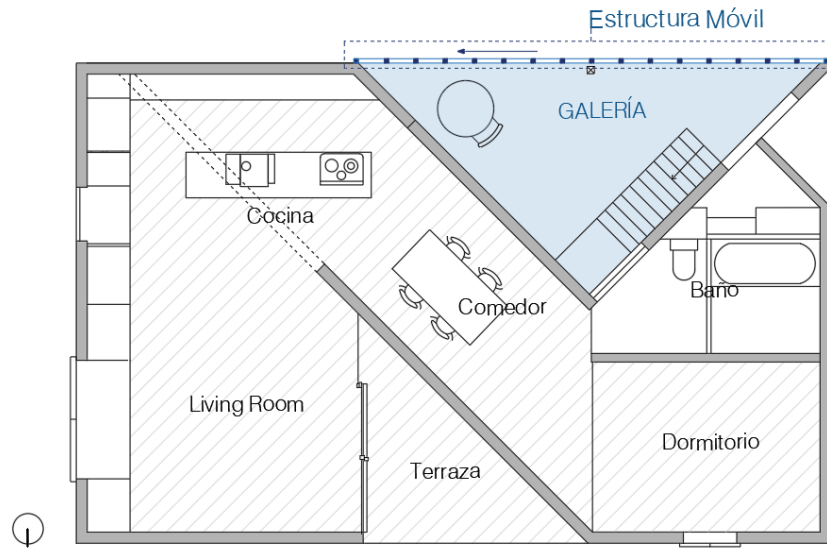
Planta primer nivel de casa en Sonobe. Fuente: Elaboración propia en base a Tato Architects.
